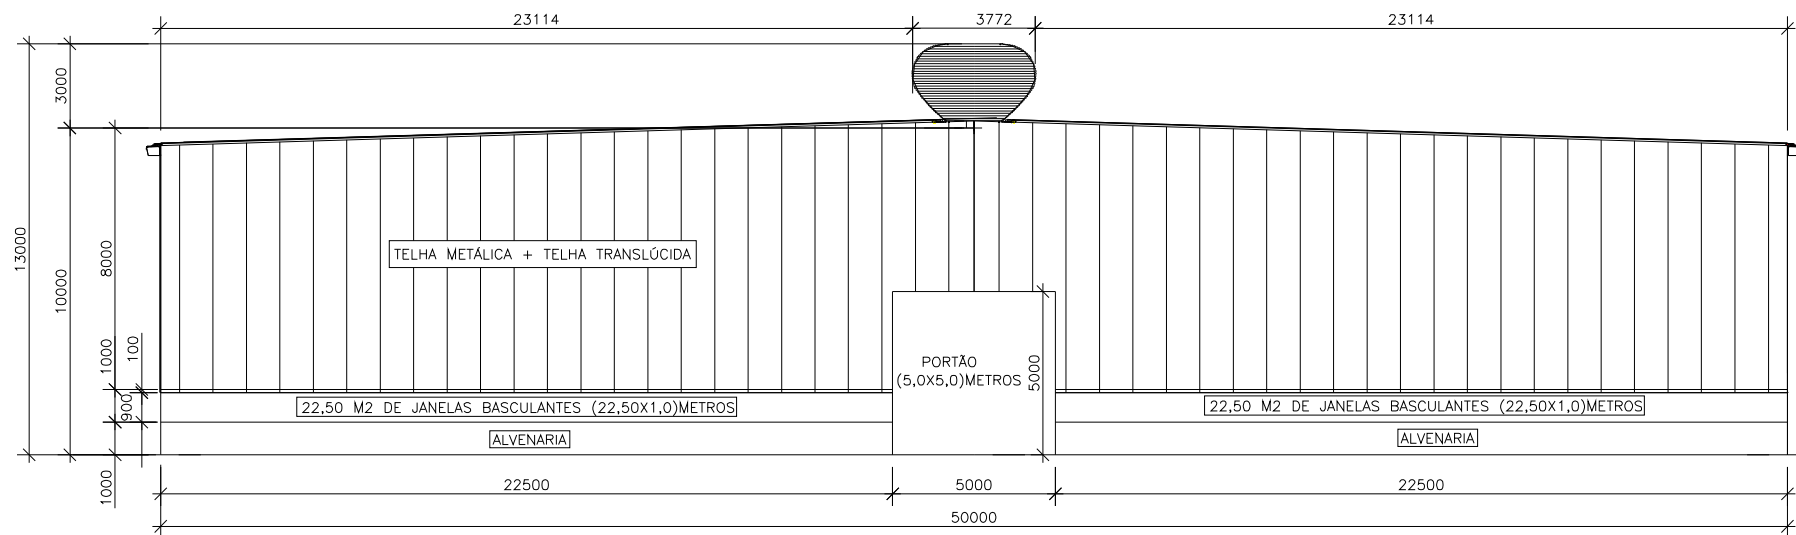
Fachada frontal do pavilhão industrial (Silvani, 2005, p.62)
